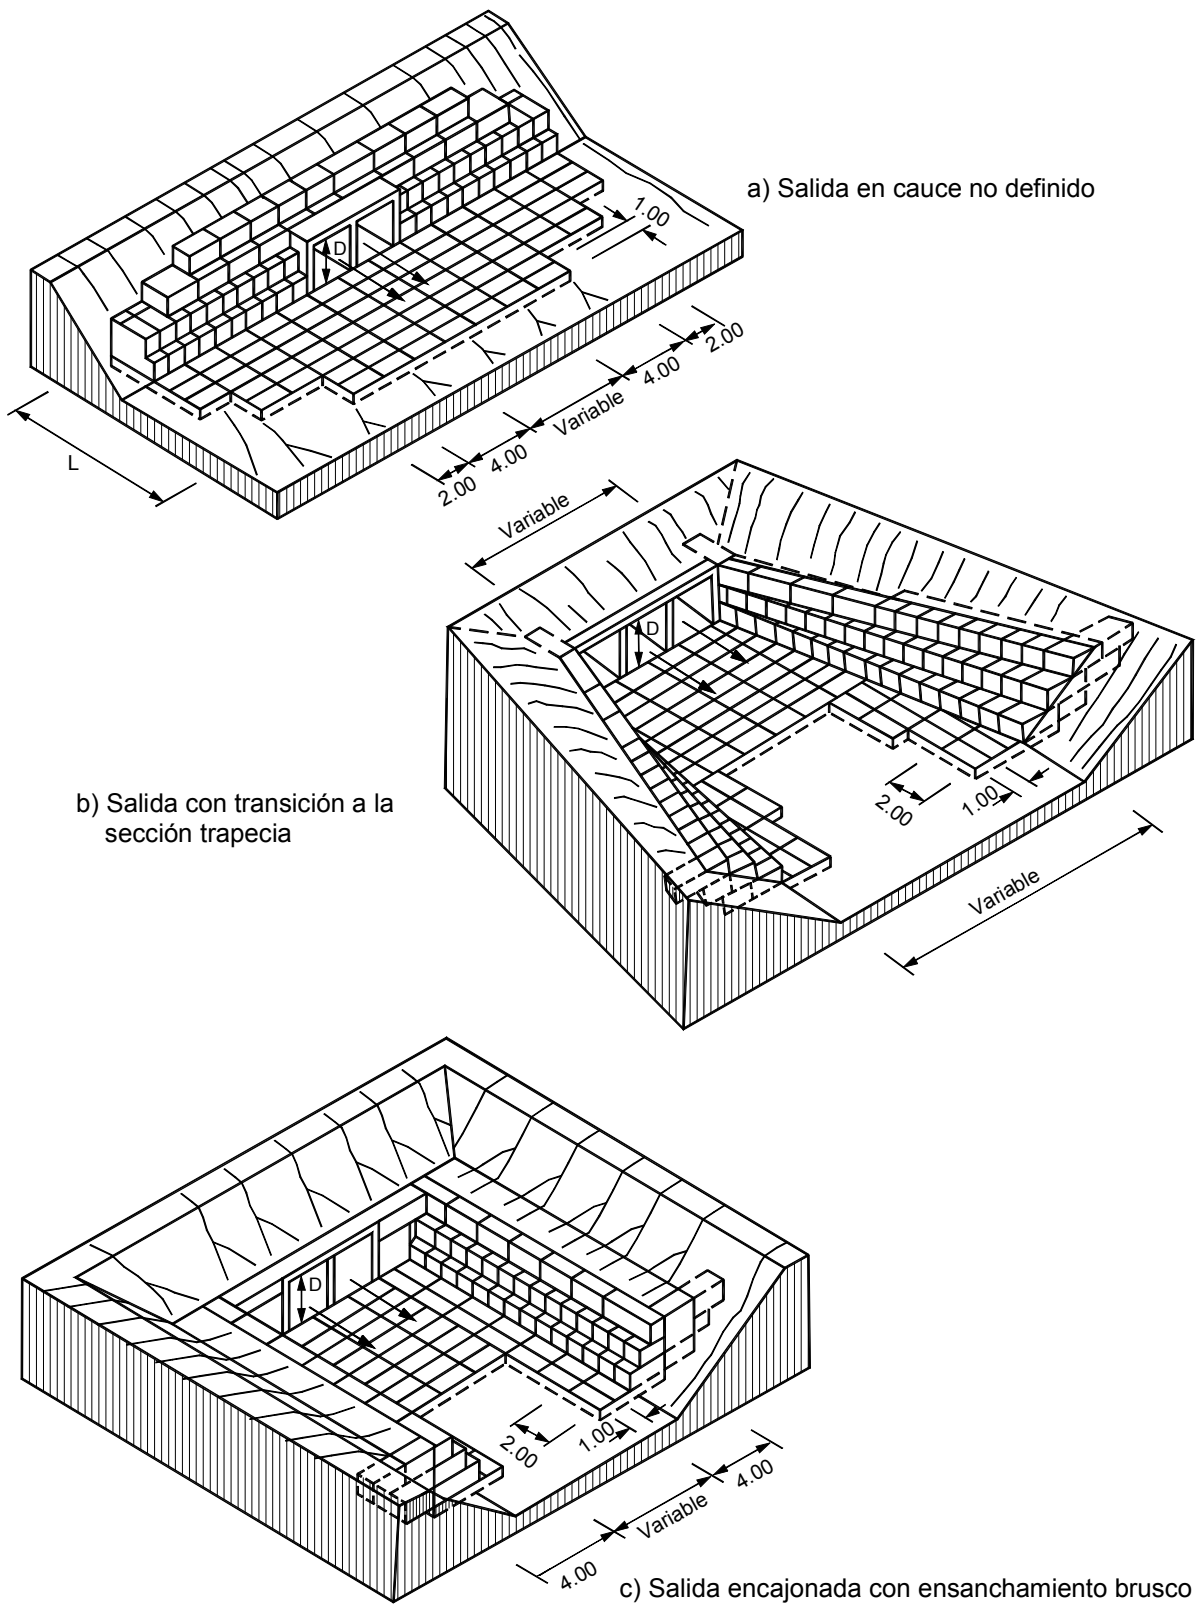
Protección en gaviones para box culverts compuestos.
